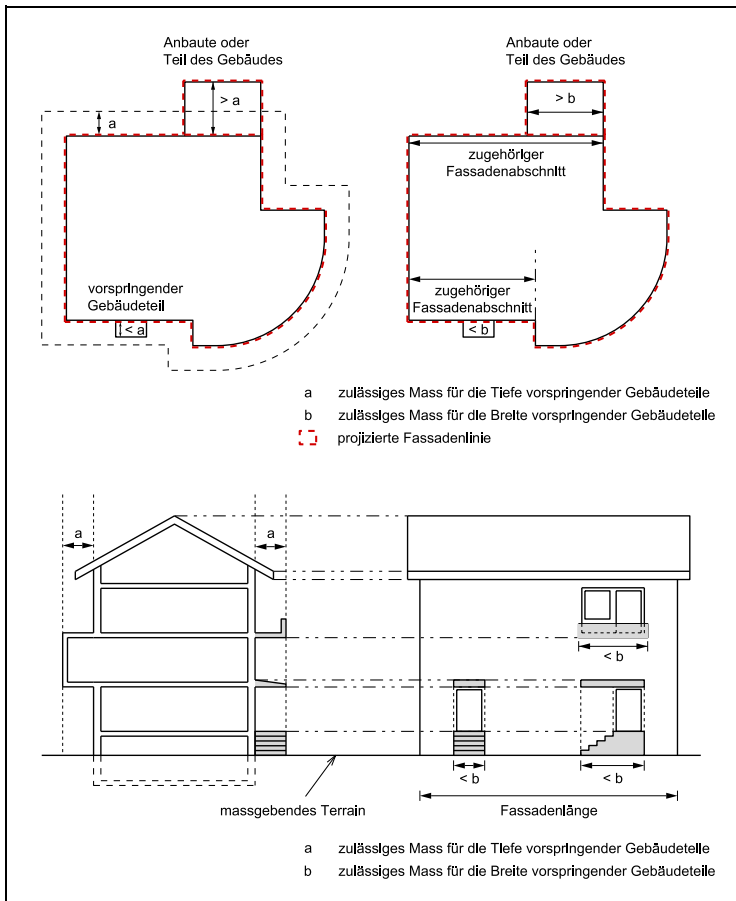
und 3.2 Fassadenflucht und Fassadenlinie (§§ 6, 6 a ABV)
